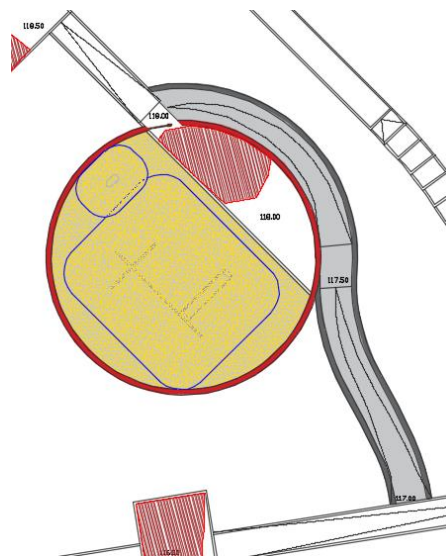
Planta de Pavimento – Área Muro Vermelho
